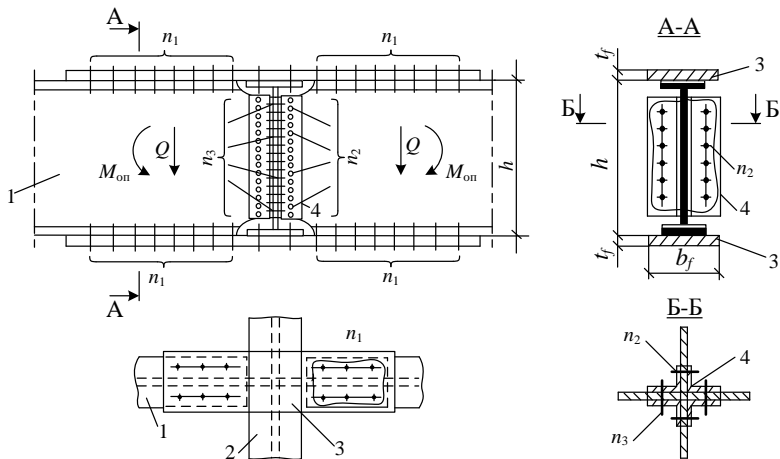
Схема прикрепления продольных балок к поперечной:
